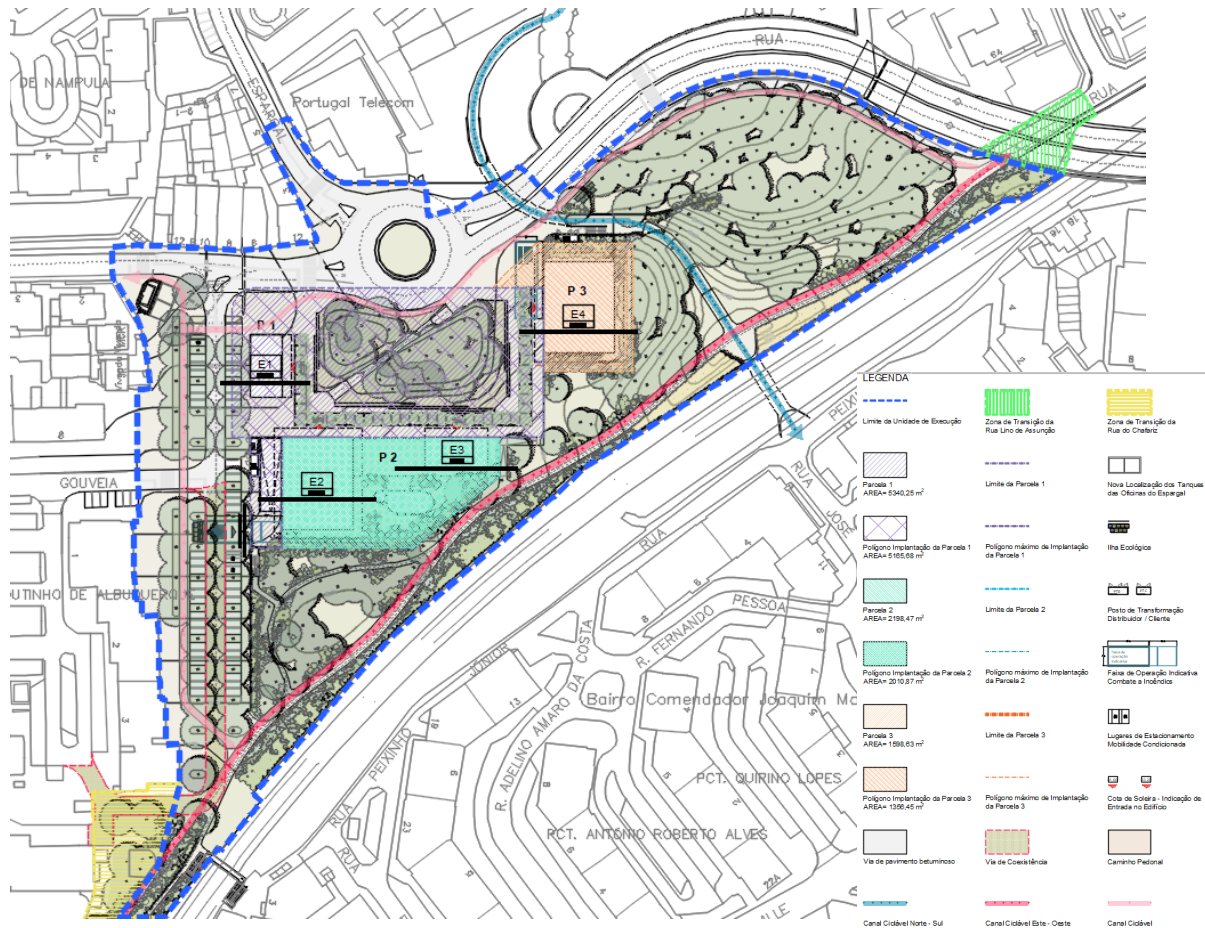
Planta Síntese da Unid. de Execução Espargal.
